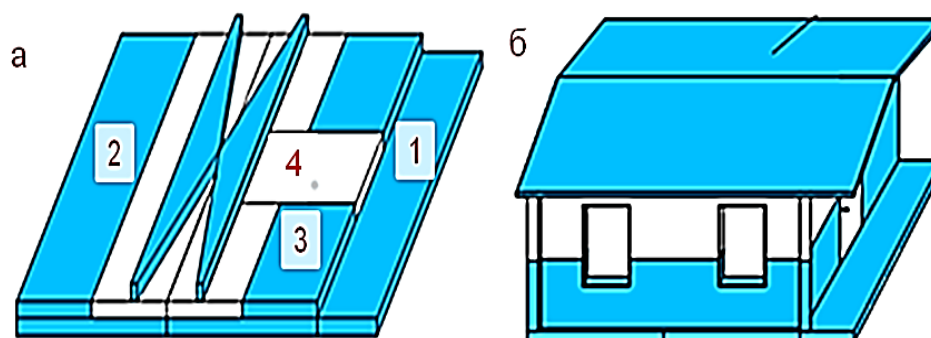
Внешний вид сборно-разборного объемного блок-модуля:
